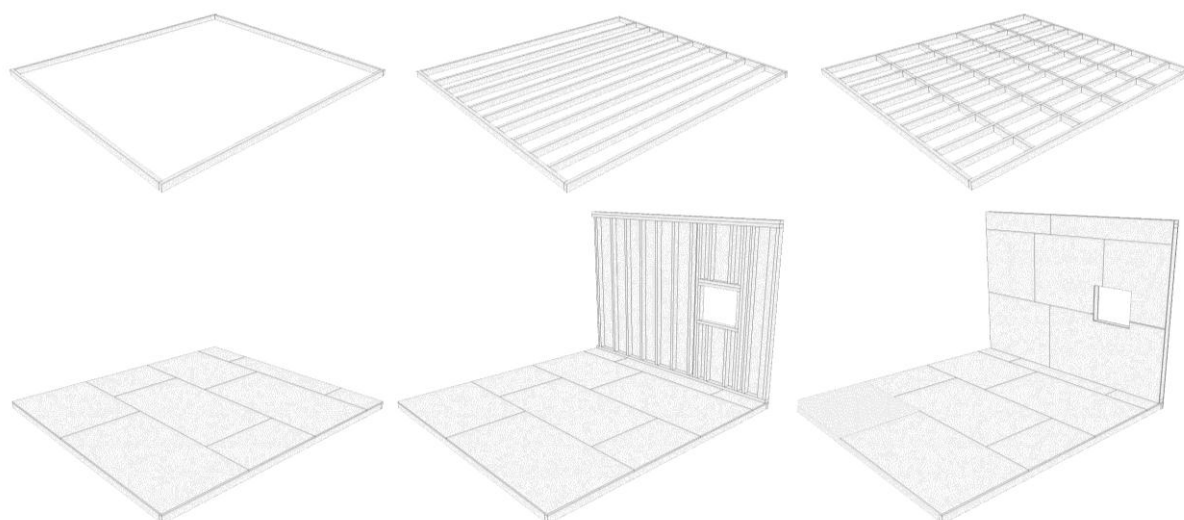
Esquema construtivo do sistema de madeira aligeirada. Construção de um pavimento, de uma parede e junção dos dois elementos.
